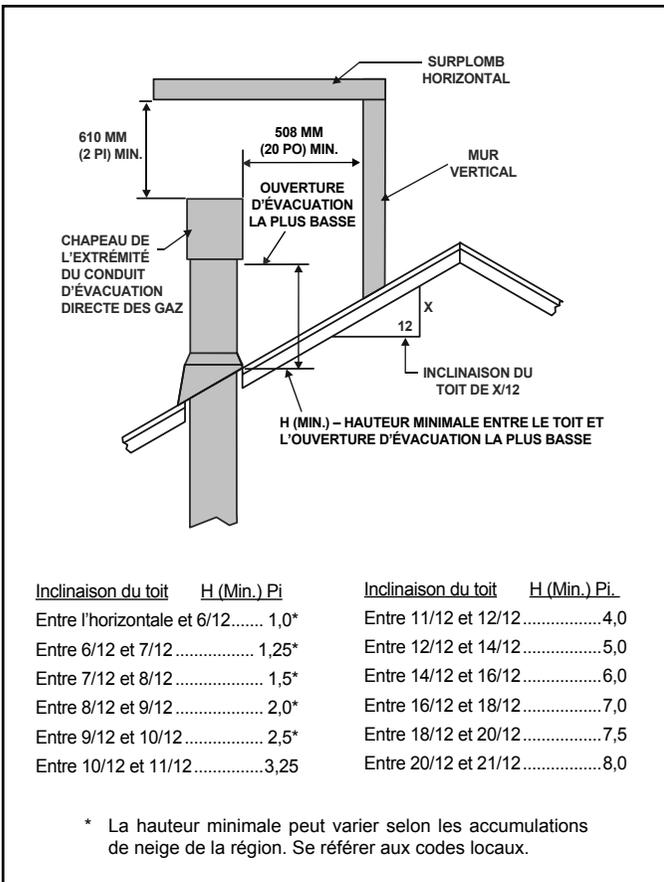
Hauteur minimale entre le toit et l'ouverture d'évacuation la plus basse
